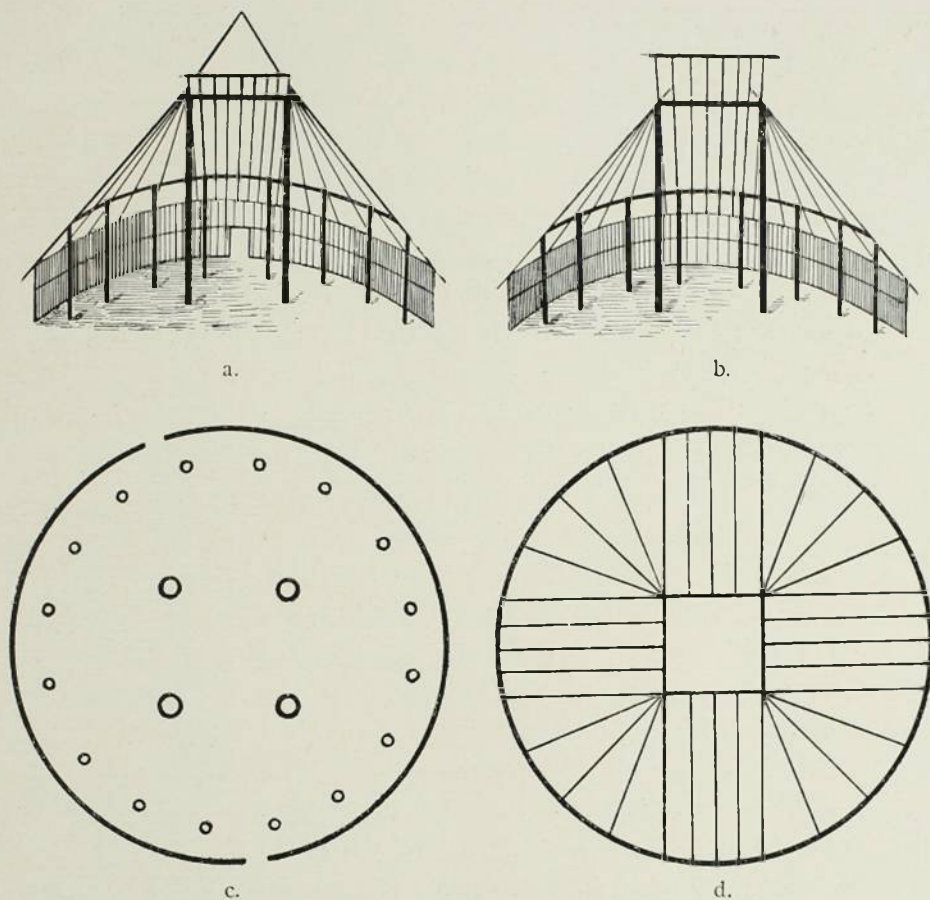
Plan einer Maloka am unteren Apaporis. a. und b. Innenkonstruktion. c. Grundriß. d. Dachkonstruktion.
